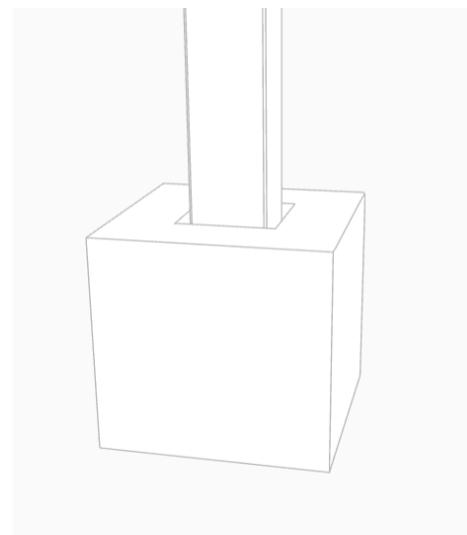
Imagen 3D de la zapata de cáliz con la llegada del pilar [13]
